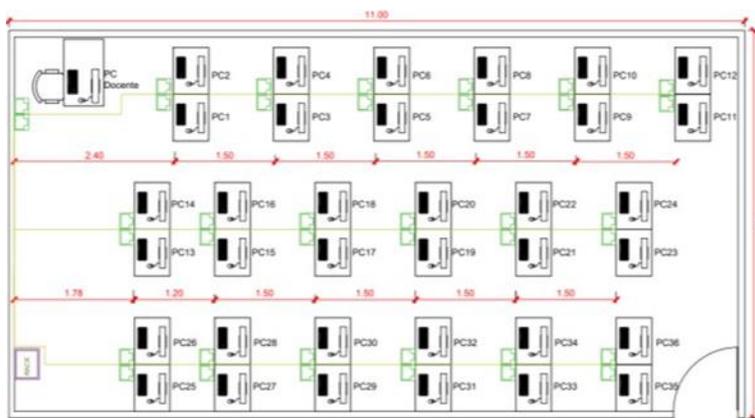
Plano estructurado de vista cenital para el laboratorio de computación de la “Escuela General Artigas”.
